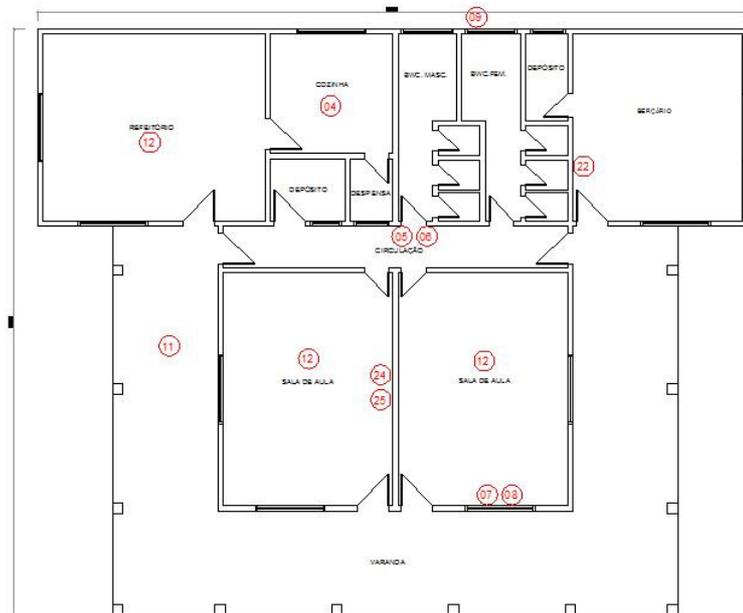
Planta Baixa creche Peixinho Dourado – Balneário Rincão
